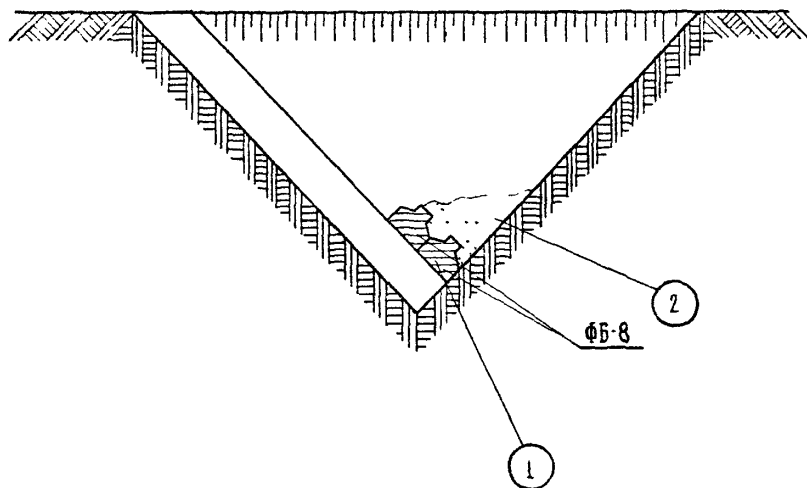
Последовательность монтажа анкерного фундамента. I этап
